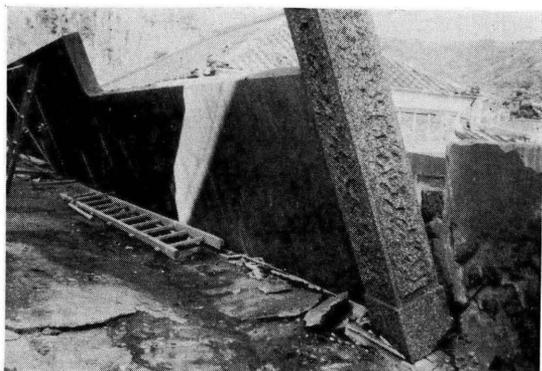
入間：沈下し傾斜したコンクリートペイ
